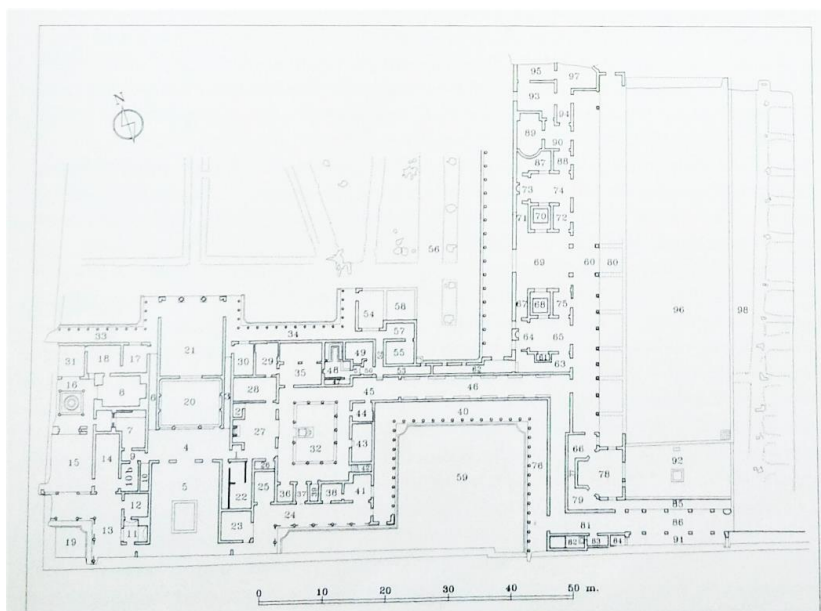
Planimetría de la Villa de Poppea. (numeración dada en las excavaciones)
